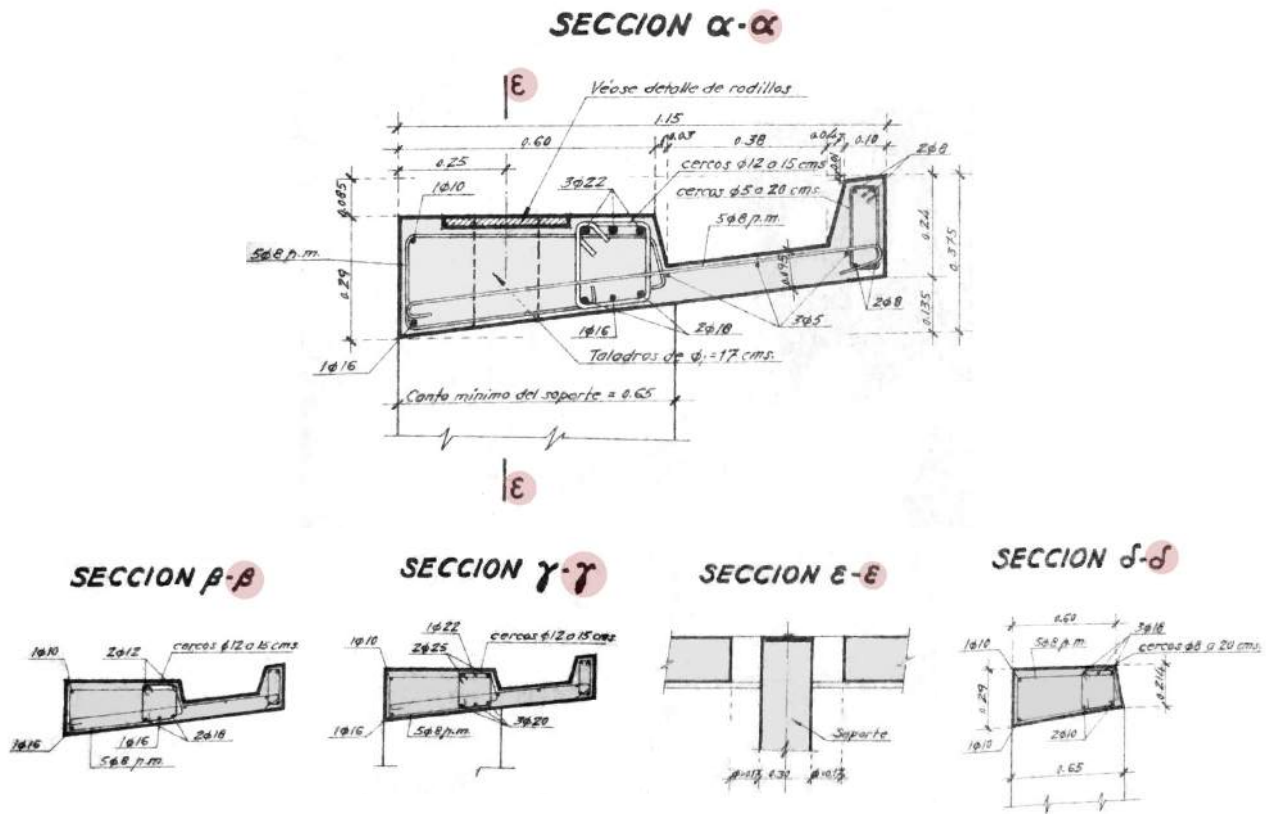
DETALLES DE LOS PÓRTICOS DE FACHADA - SECCIONES α β γ ϵ Y δ
